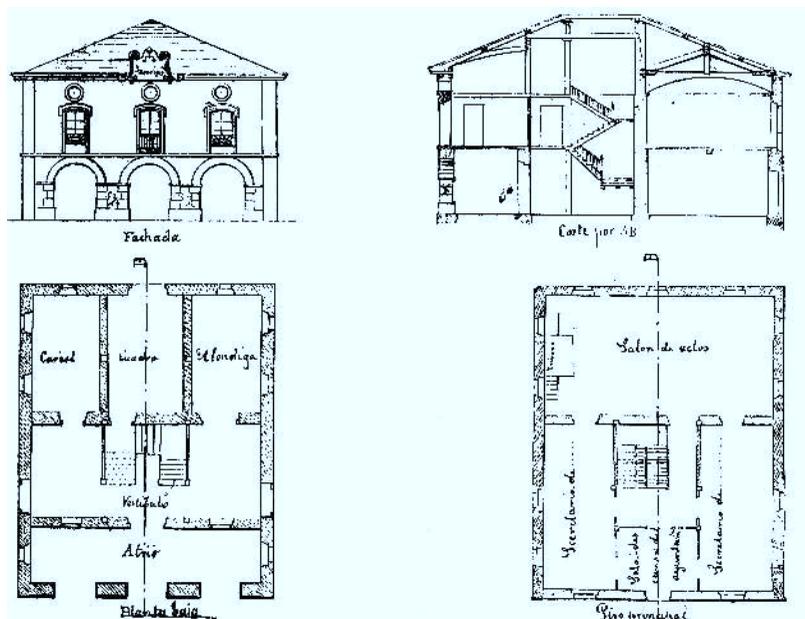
y 2.: Proyecto de reconstrucción de la Casa Consistorial de Carranza realizado en 1876 por el maestro de obras Francisco de Echevarría. Alzado de la fachada principal y planta baja. (Derribado). Sección y planta del piso principal. (Derribado).
